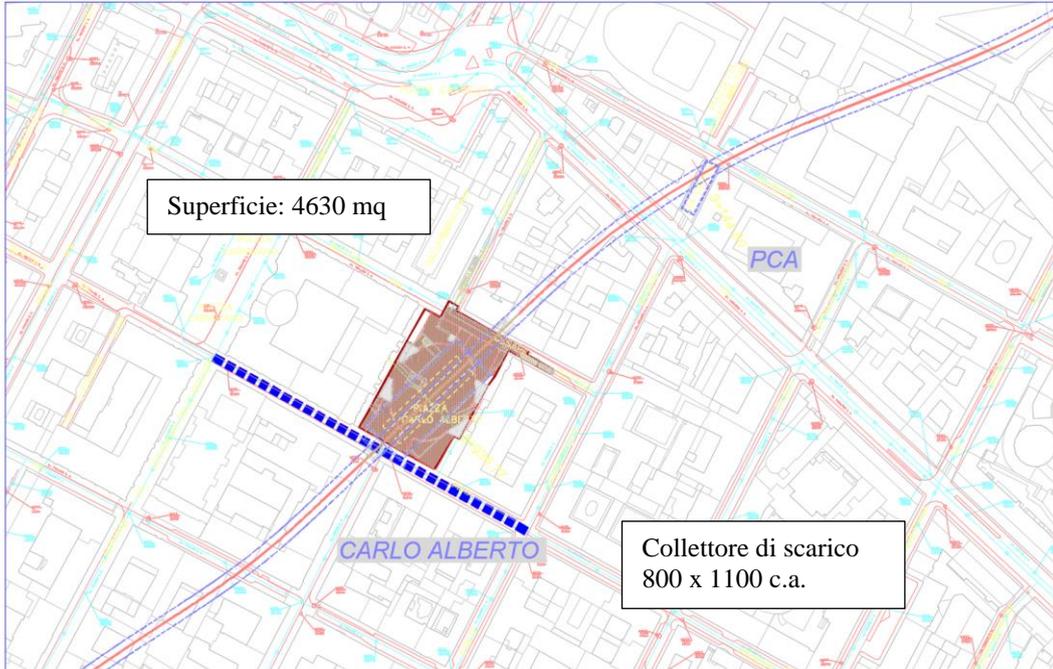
Aree di cantiere – Stazione Carlo Alberto – FASE 2A
